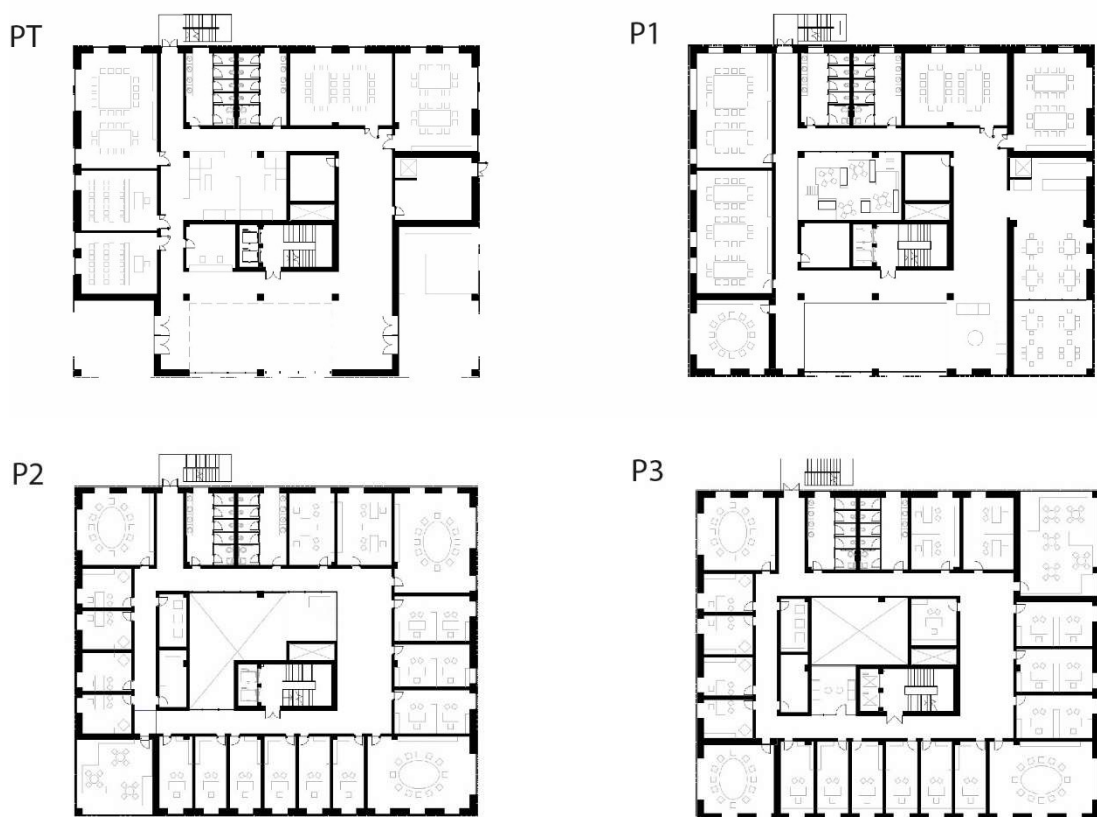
Pianta architettoniche, individuazione dei locali del caso studio
